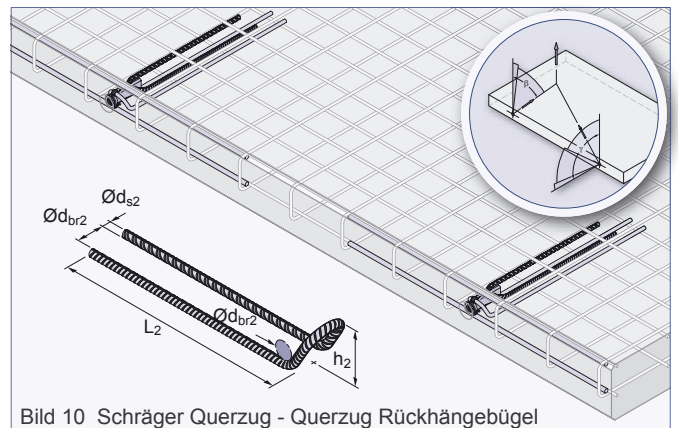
Schräger Querzug - Querzug Rückhängebügel
